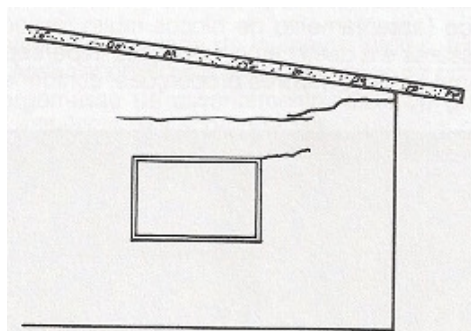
Fissuras em parede externa promovidas pela retração da laje de cobertura
